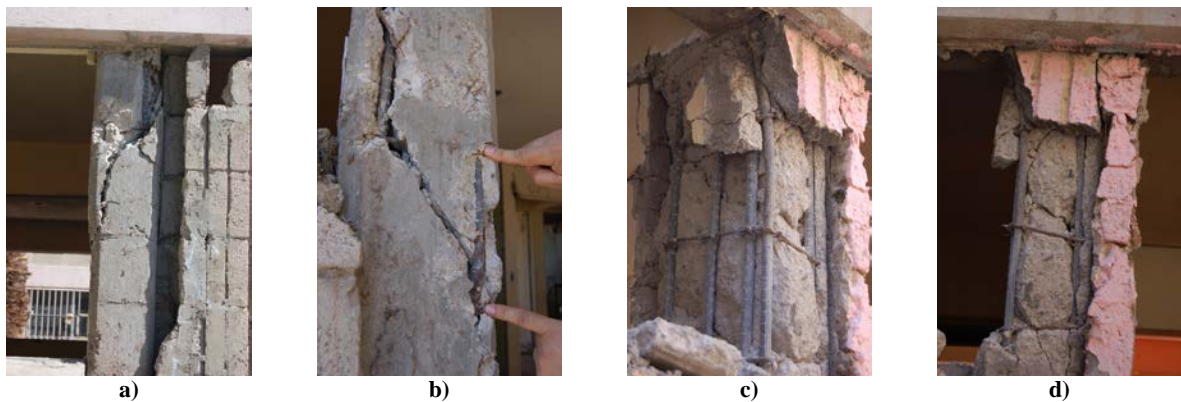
Columnas cortas observadas en la planta baja de los multifamiliares Monte Albán.
